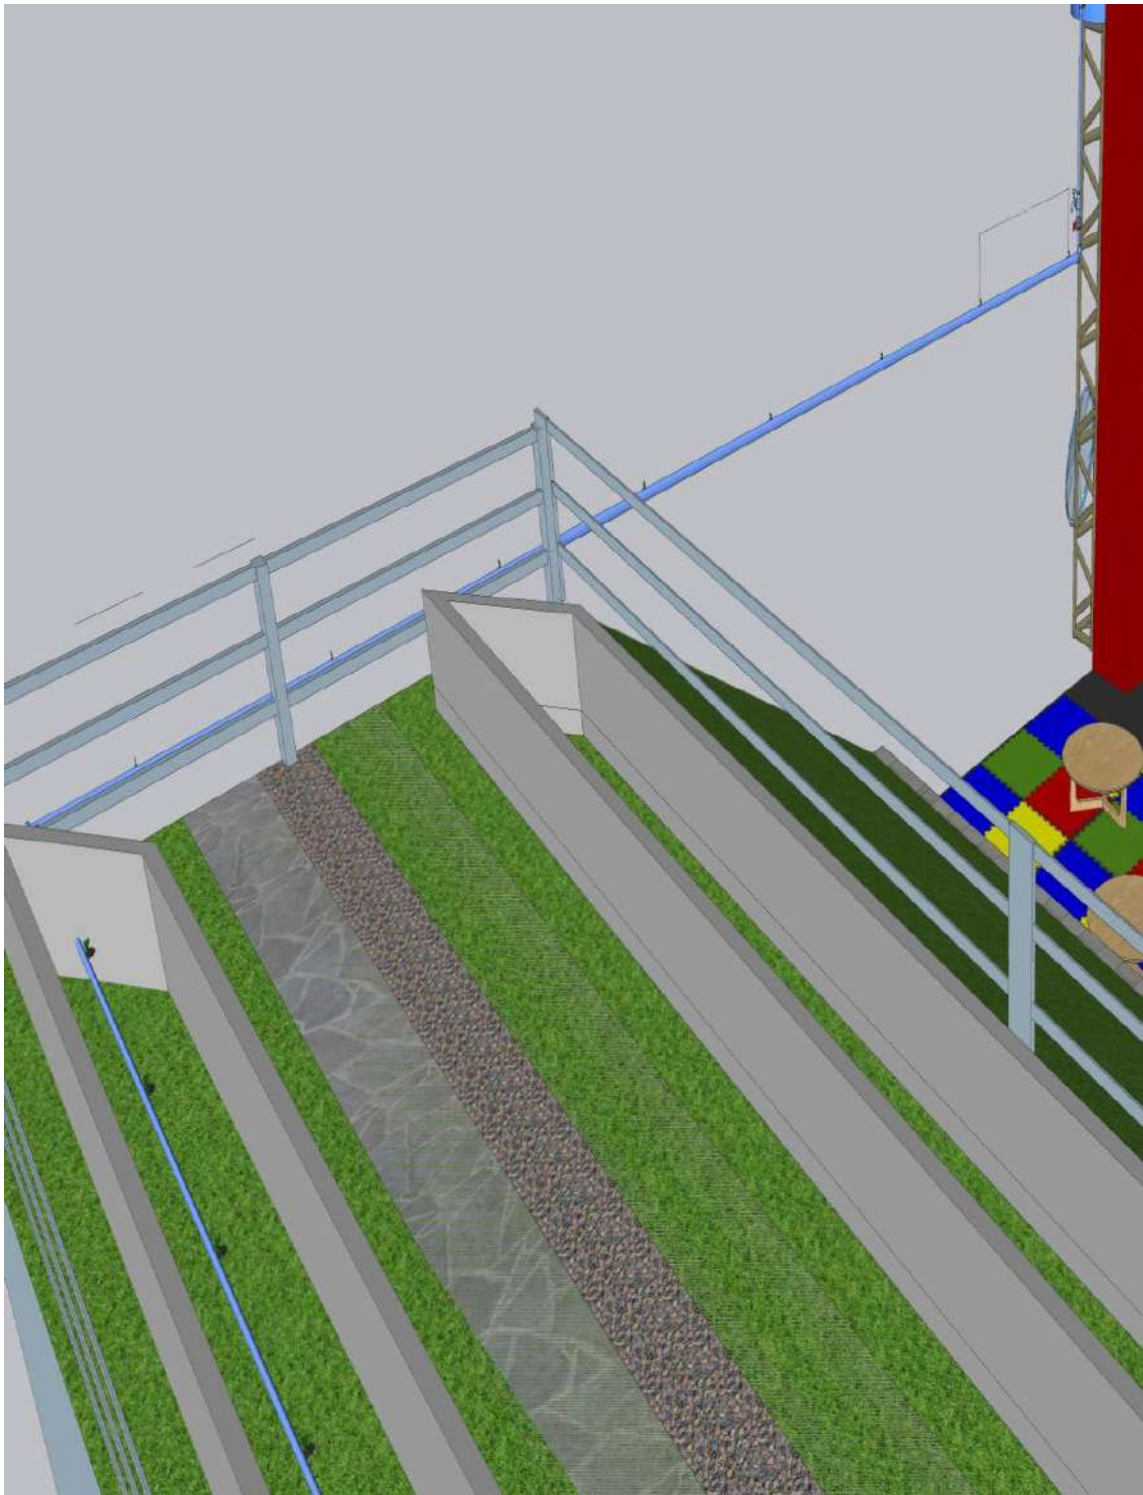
Planta 3D – Canteiro com sistema de gotejamento
